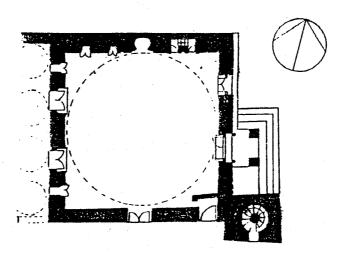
مسقط أفقي لمسجد تمور باليمن . (عن : فنستر) .
